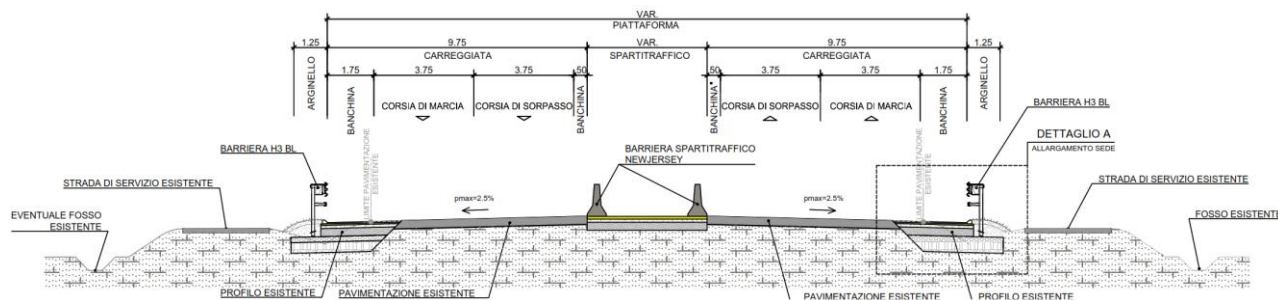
Sezione tipologica in rettilineo con strada di servizio
